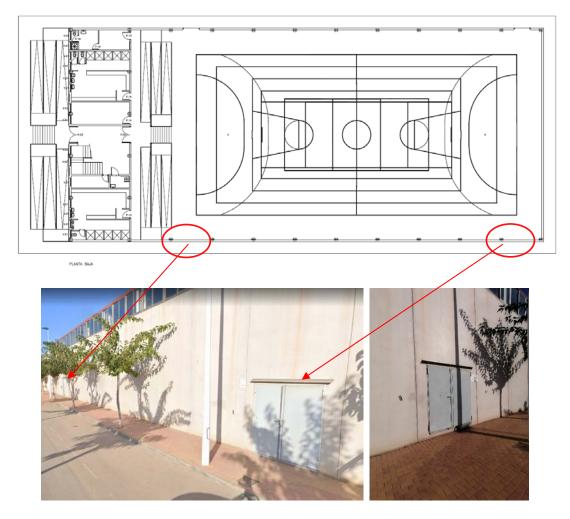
Accesos al pabellón deportivo en orientación sureste. Detalle de puerta de acceso
